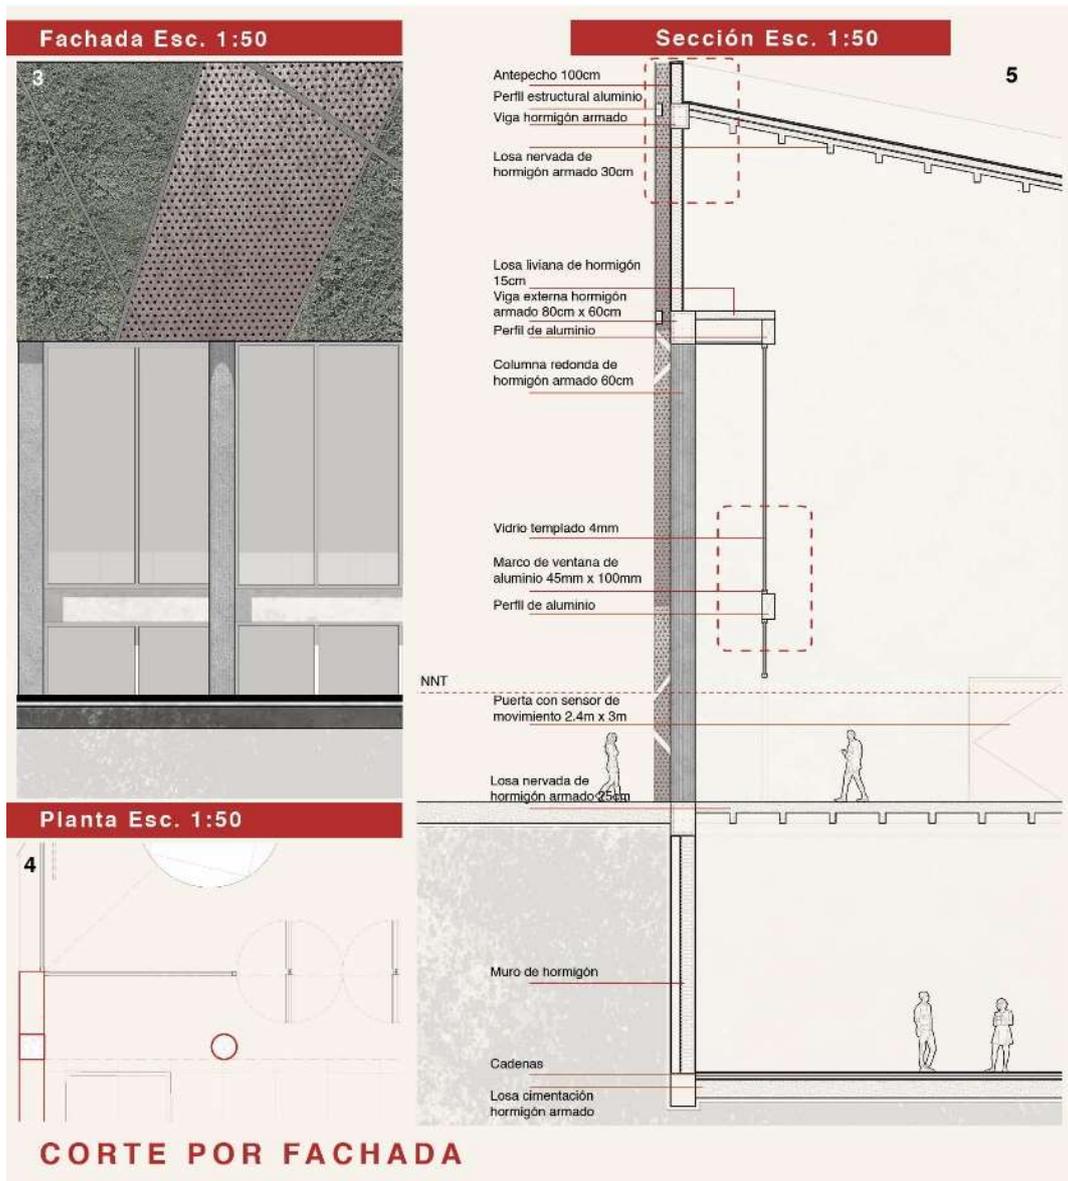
Detalle Constructivo. Corte por Fachada. Elaboración propia.
